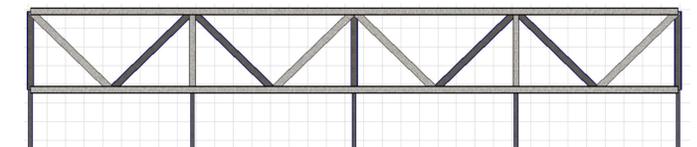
Ansicht Fachwerk mit aufgehängten Fassadenstützen
